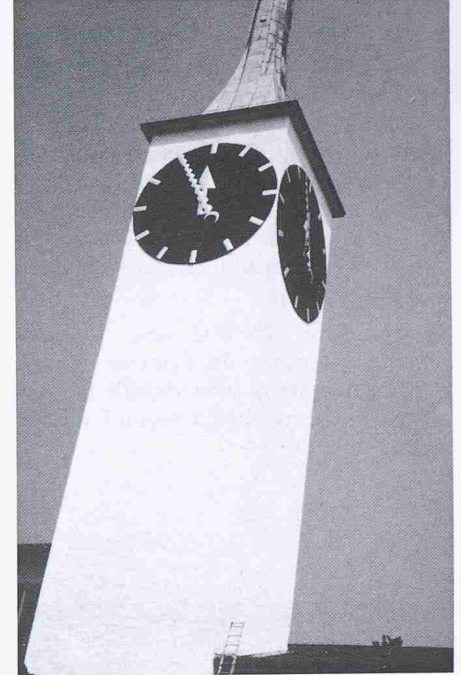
Kirchturm Beton-verputzt vor 50 Jahren. Zustand nach Sanierung mit Spritzbeton in «Putzstruktur» 1987 als Gesamterneuerung Armierungsüberdeckung.
